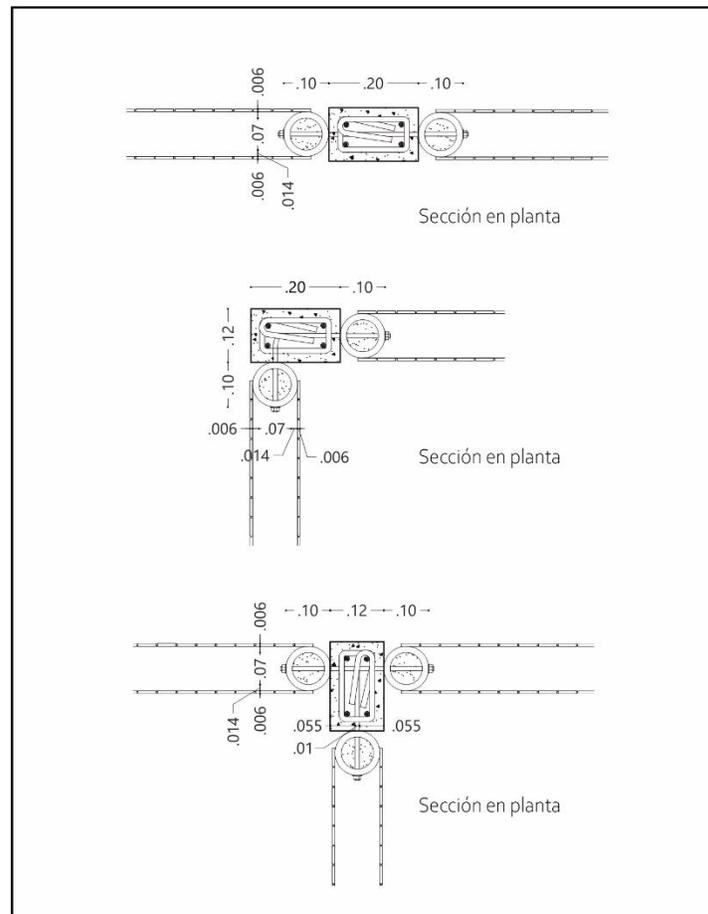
Sistema de anclaje entre armazón de columna y guadua
